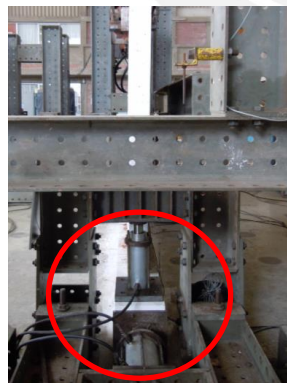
Gatas vertical y horizontal aplicadas en la viga de cimentación
